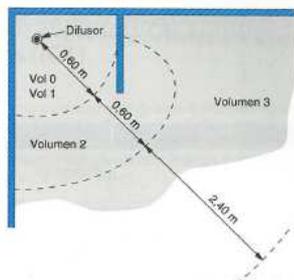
, Ducha sin plato, con pared y difusor fijo (alzado).
